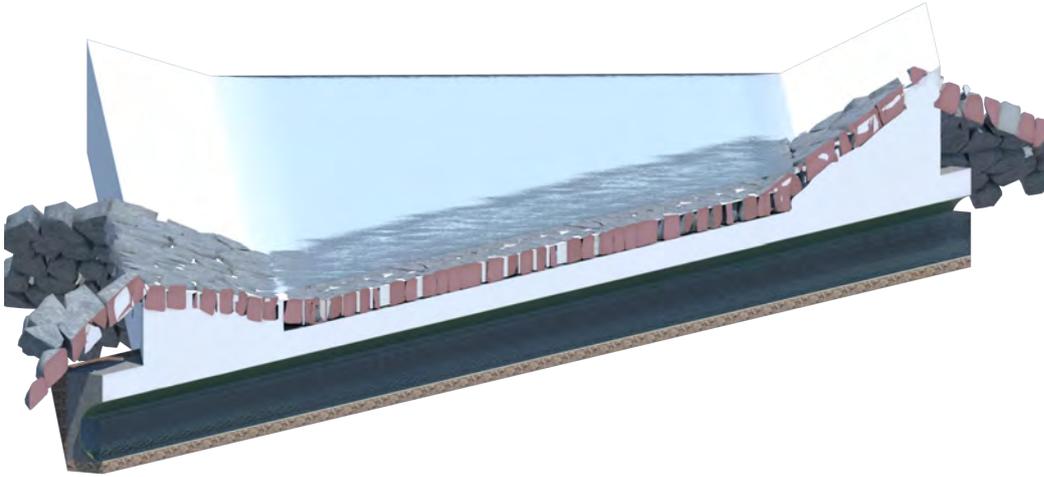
Spaccato assonometrico dell'attraversamento in sub-alveo.
